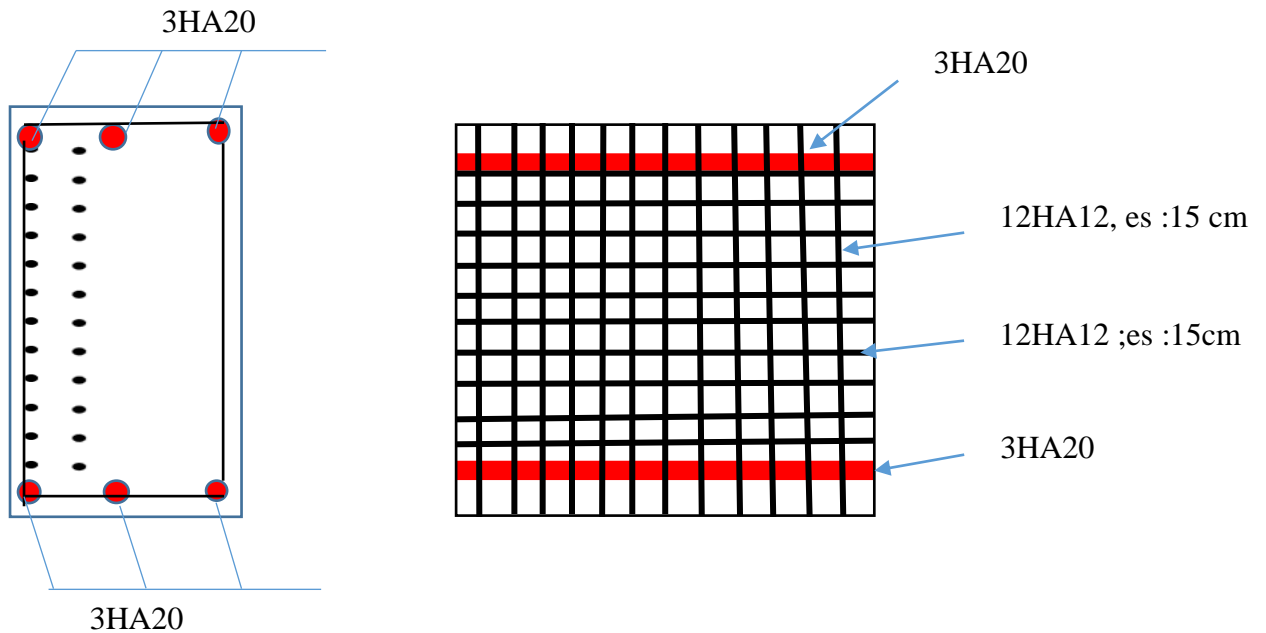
Schéma de Ferrailage de l'entretoise.
